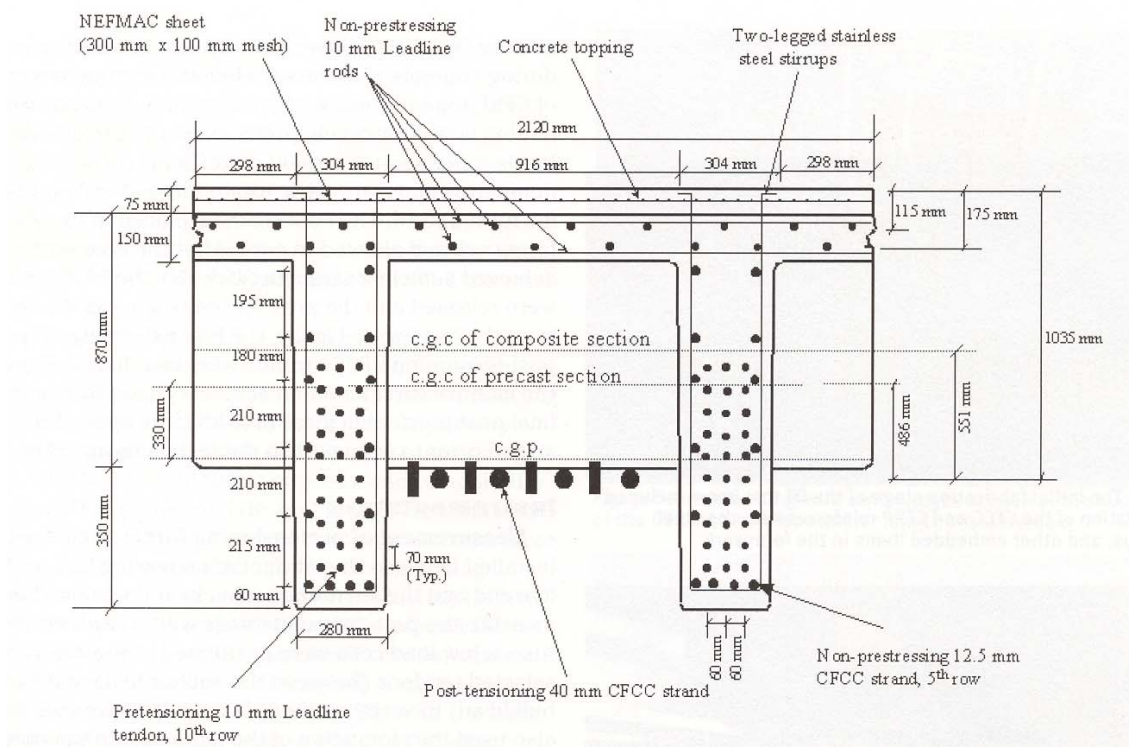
Querschnitt Bridge Street Bridge [www.ovbb.at]
